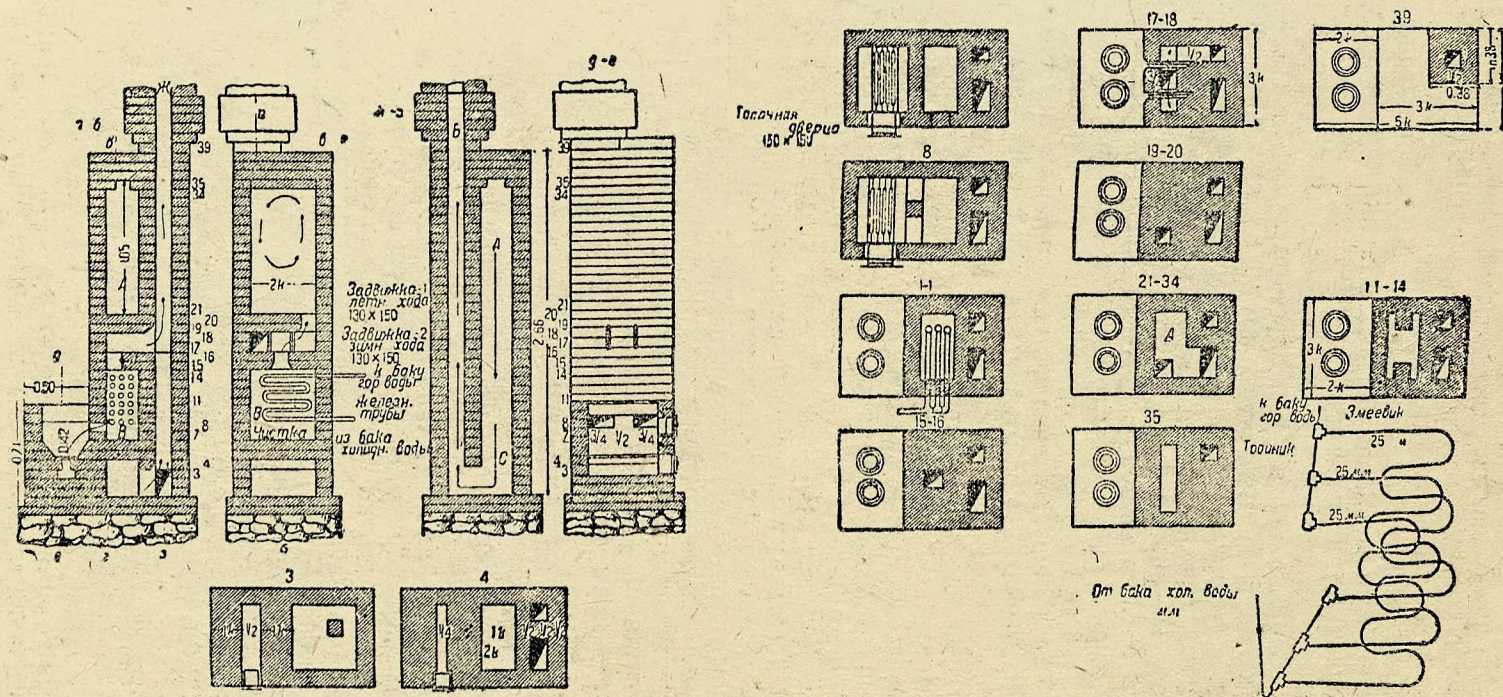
Кухонный квартирный очаг на две конфорки со щитом конструкции ниж. Подгородника И. С.
